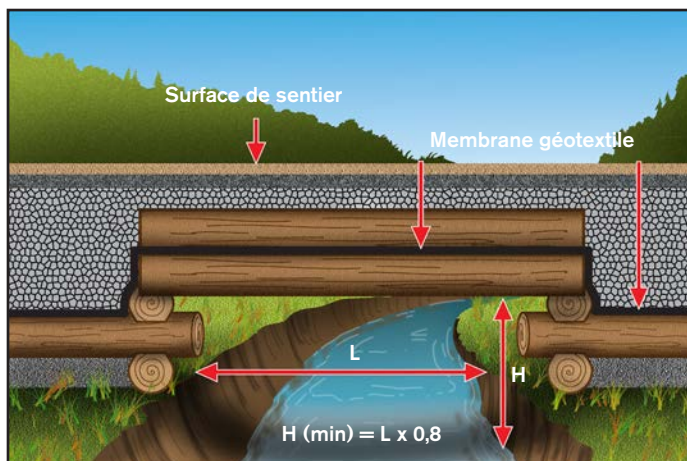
Ponceau de billes de bois et tablier de planches.
